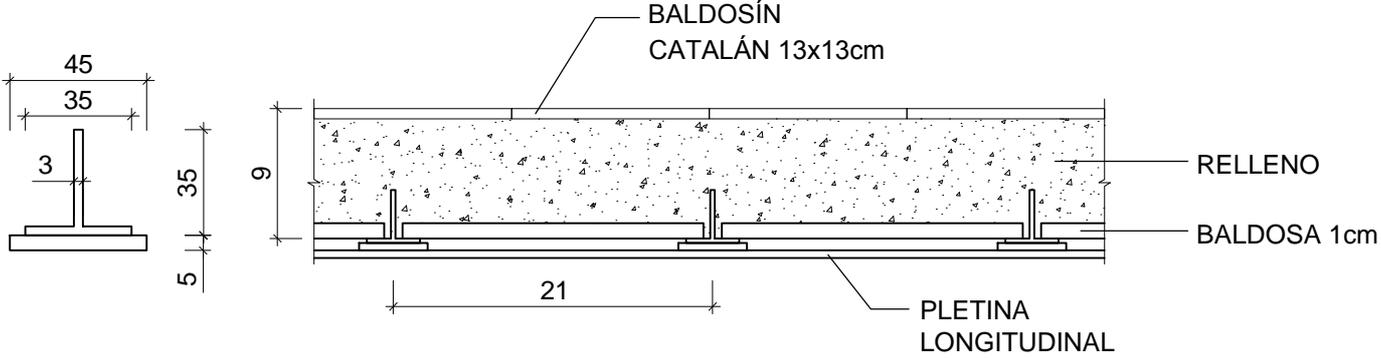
CALA SUPERIOR EN BALCÓN PLANTA TERCERA
